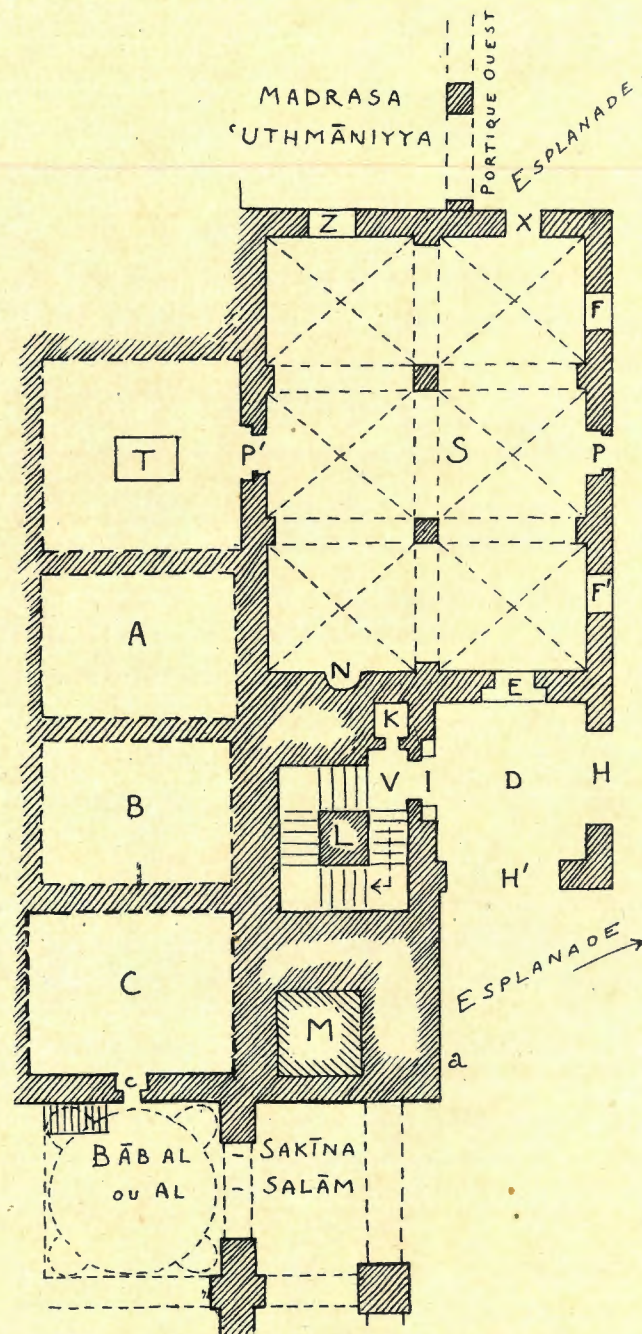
Plan de l'Ashrafiyya (rez-de-chaussée).
